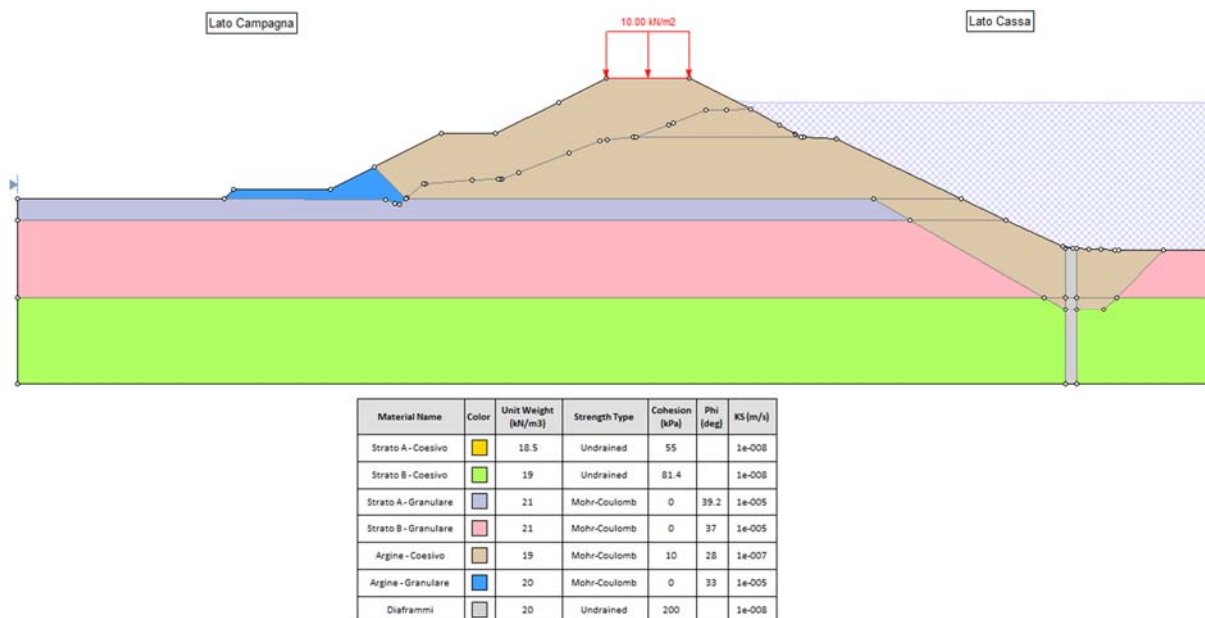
Sezione Tipo G2 - Sez. P6.46
